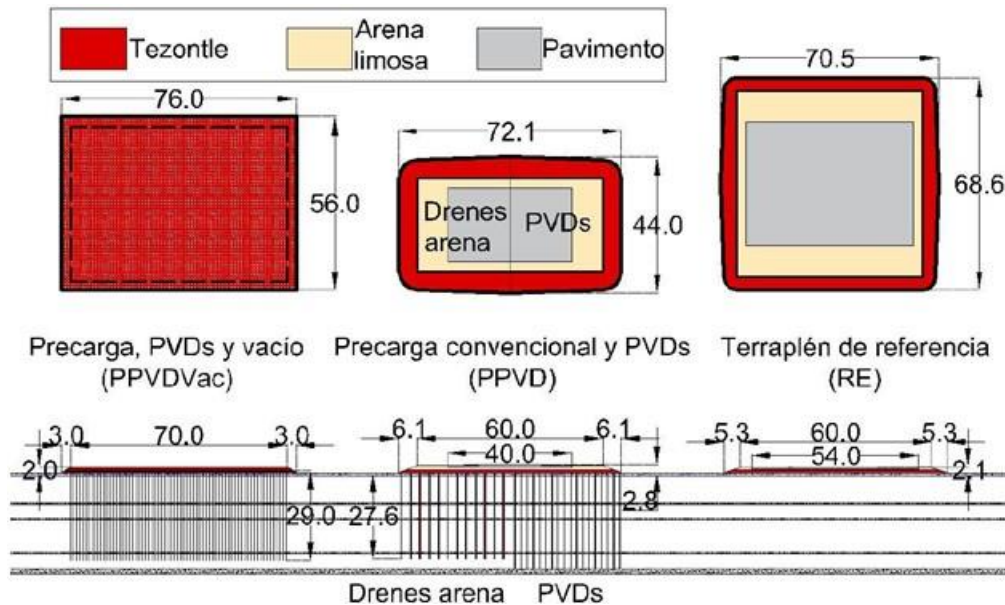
Características de los terraplenes de prueba (de referencia RE, de precarga convencional con drenes PPVD, y de precarga con drenes y vacío PPVDVac)
